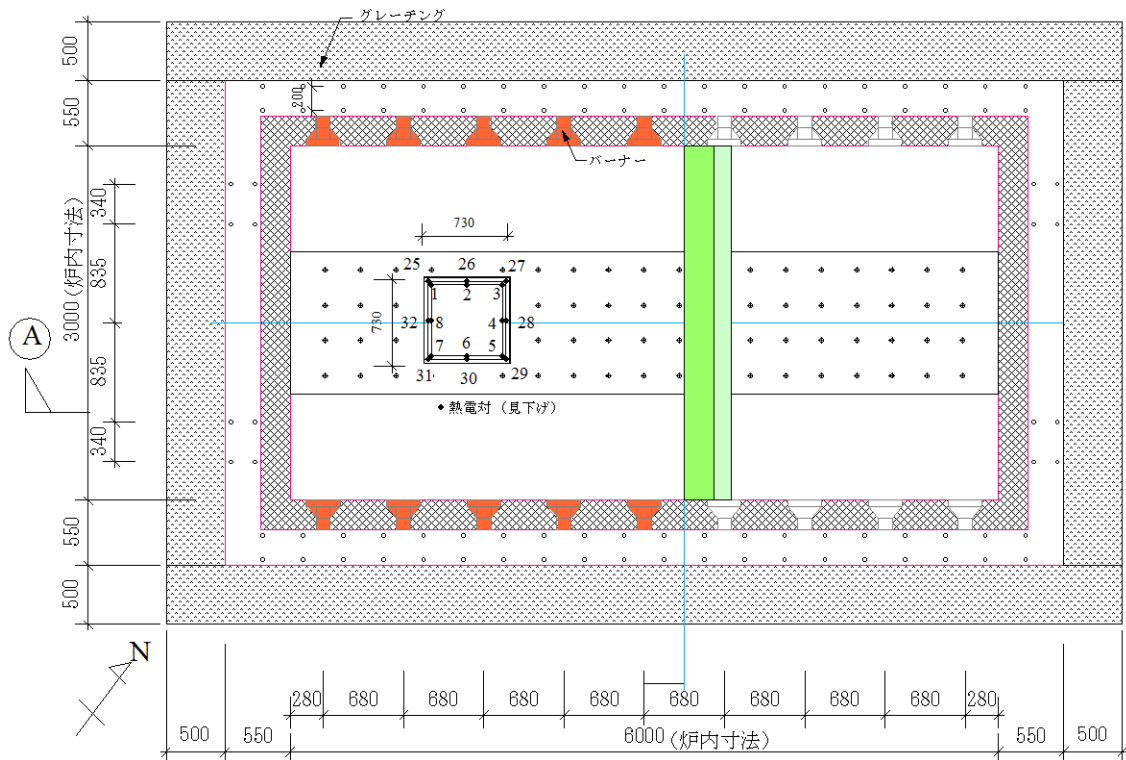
試験体配置図 (平面図 : L250C_60)
